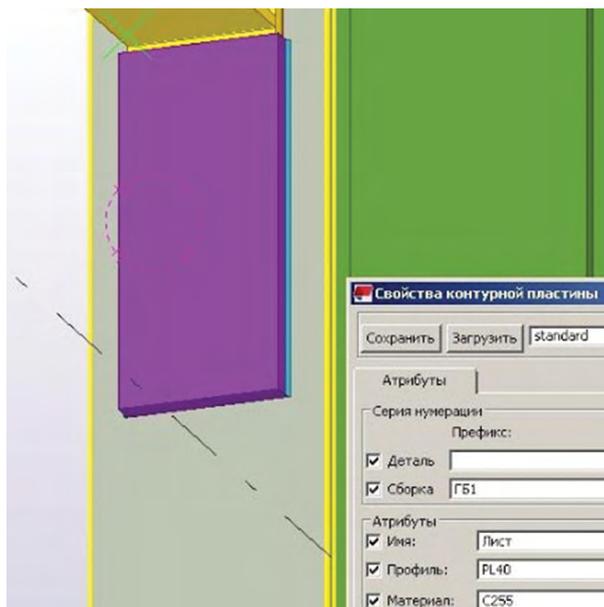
Общий вид опорного столика для крепления элемента главной балки к колонне
